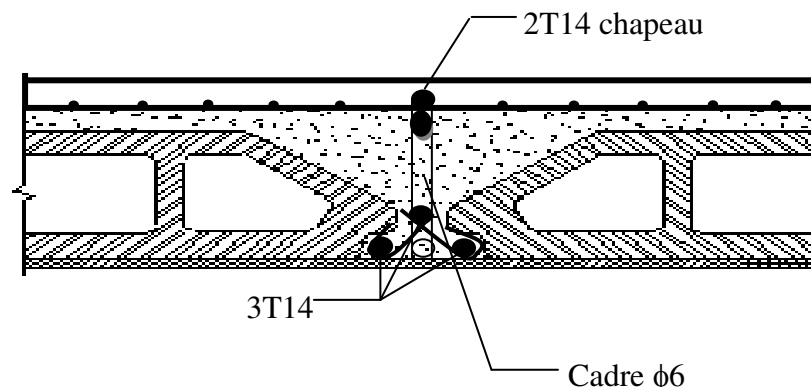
Ferraillage d'un plancher à corps creux (20+5)
